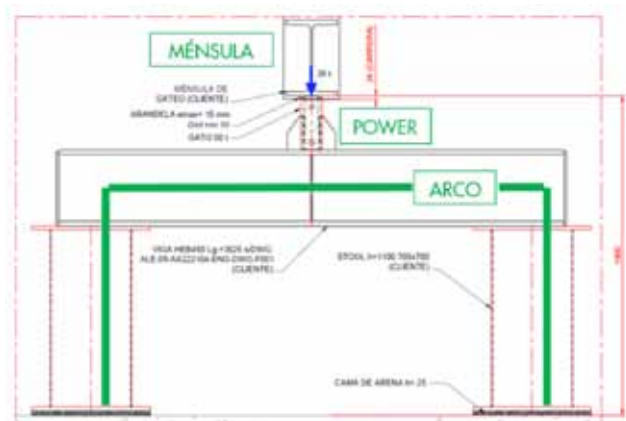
Vista lateral de estructura de soporte de del sistema de elevación.
